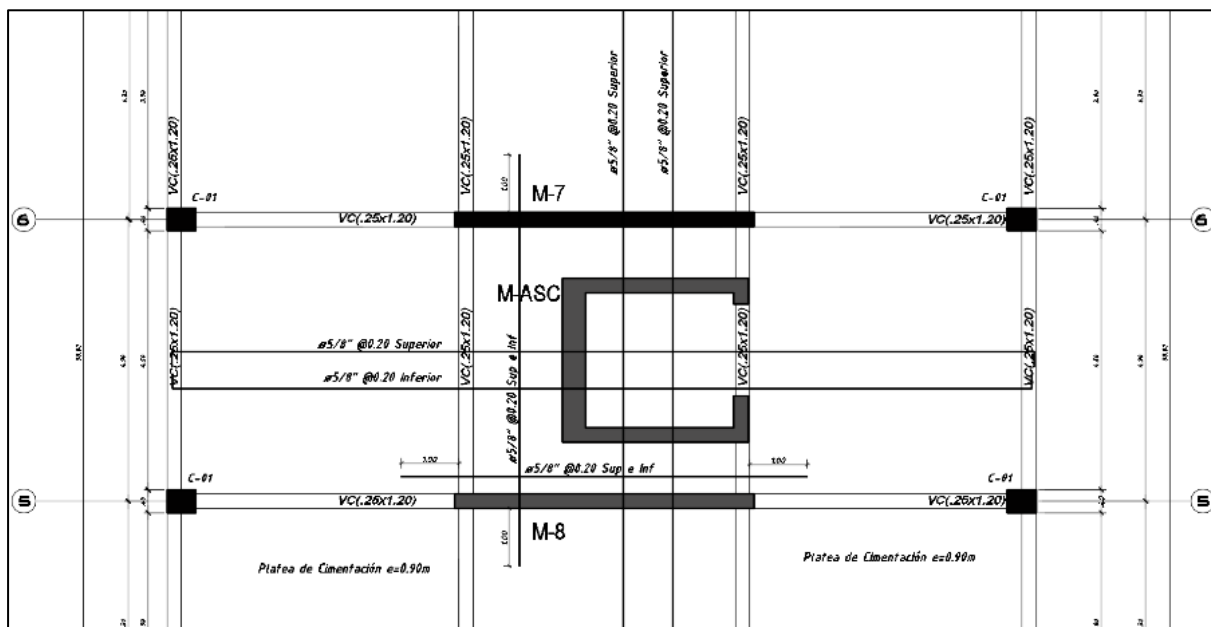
Acero longitudinal y transversal de la losa de cimentación
